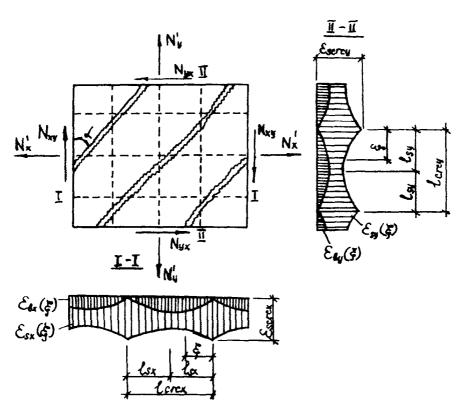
К определению расстояний между трешинами и ширины раскрытия трешин
